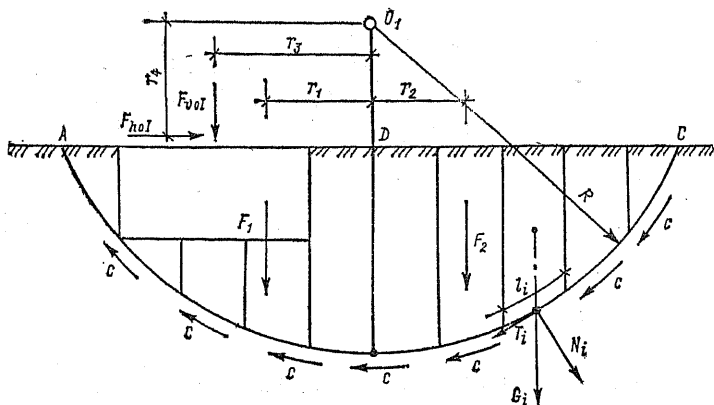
Расчетная схема к определению устойчивости фундамента с массивом грунта на сдвиг по круглоцилиндрической поверхности
